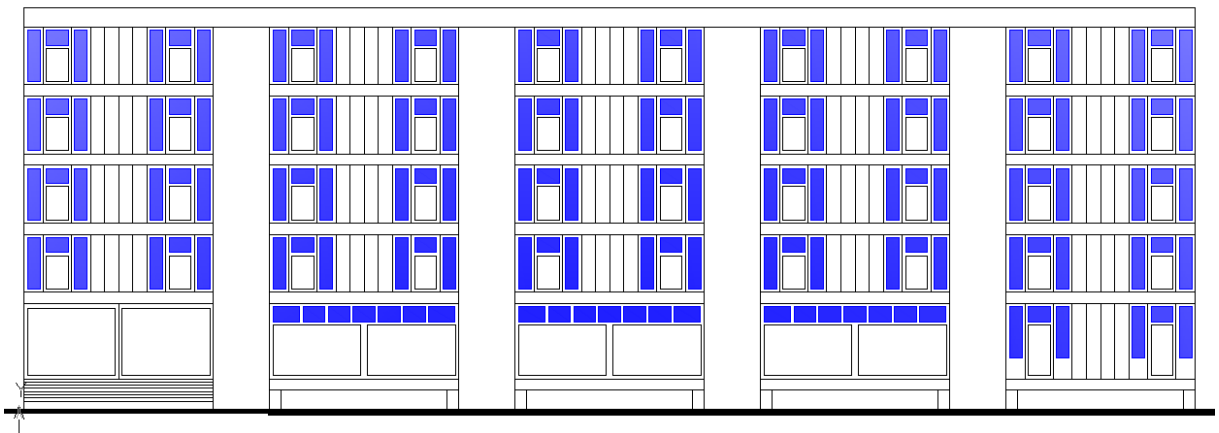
Façade Sud (place de la cité les Bananiers) dessinée sur Autodesk-Autocad.
